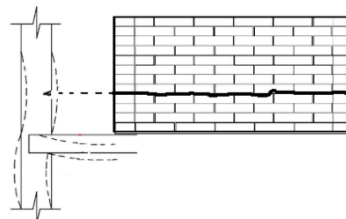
Fissuras verticais causadas por expansão da alvenaria
